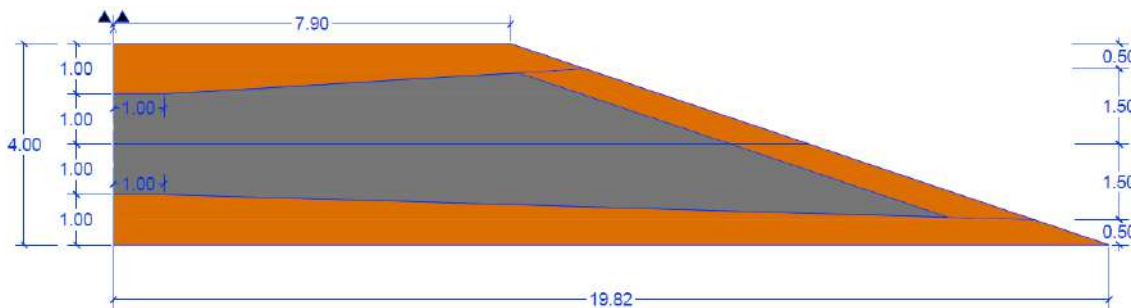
Sección R5 sin explanada (SE) con capas del terraplén no horizontales
